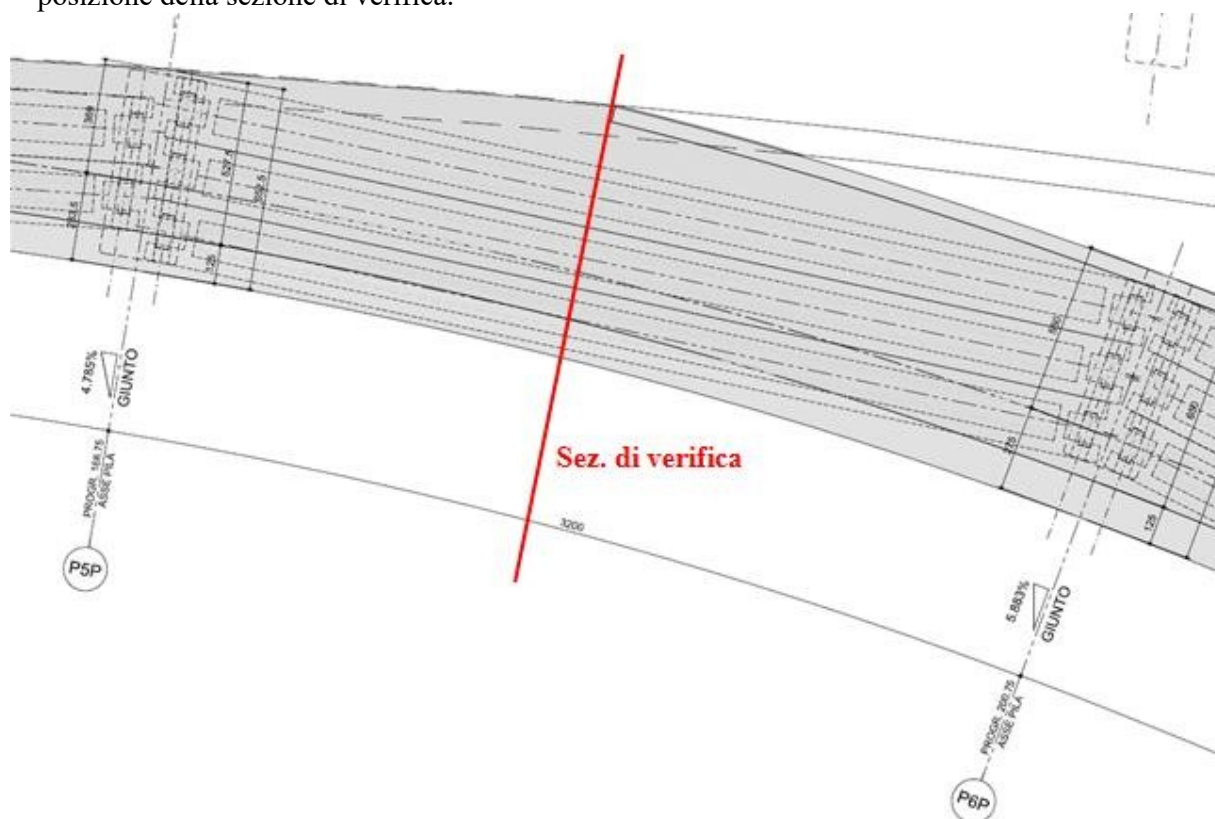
Vista planimetrica rampa P – Sezione di verifica soletta F3
